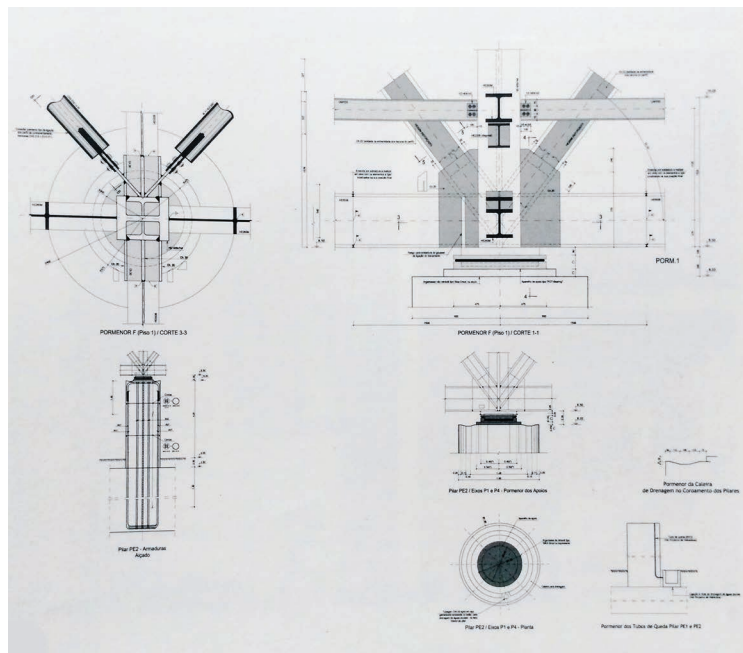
Exemplo de apresentação do pormenor construtivo de apoio da estrutura metálica nos pilares de betão armado.
